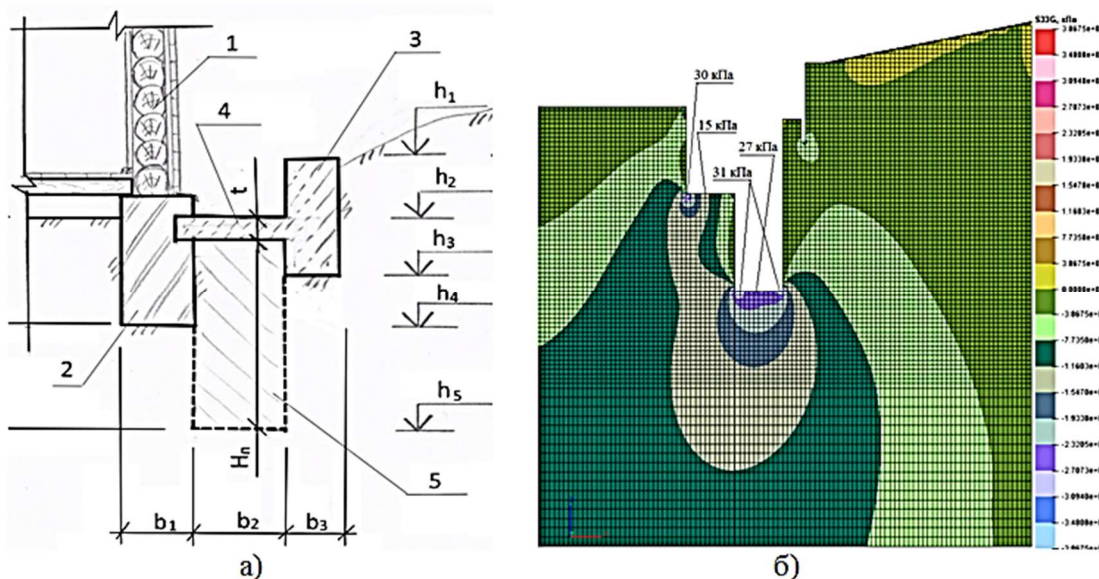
Варіант підсилення існуючого фундаменту будинку, що розташований на схилі:
